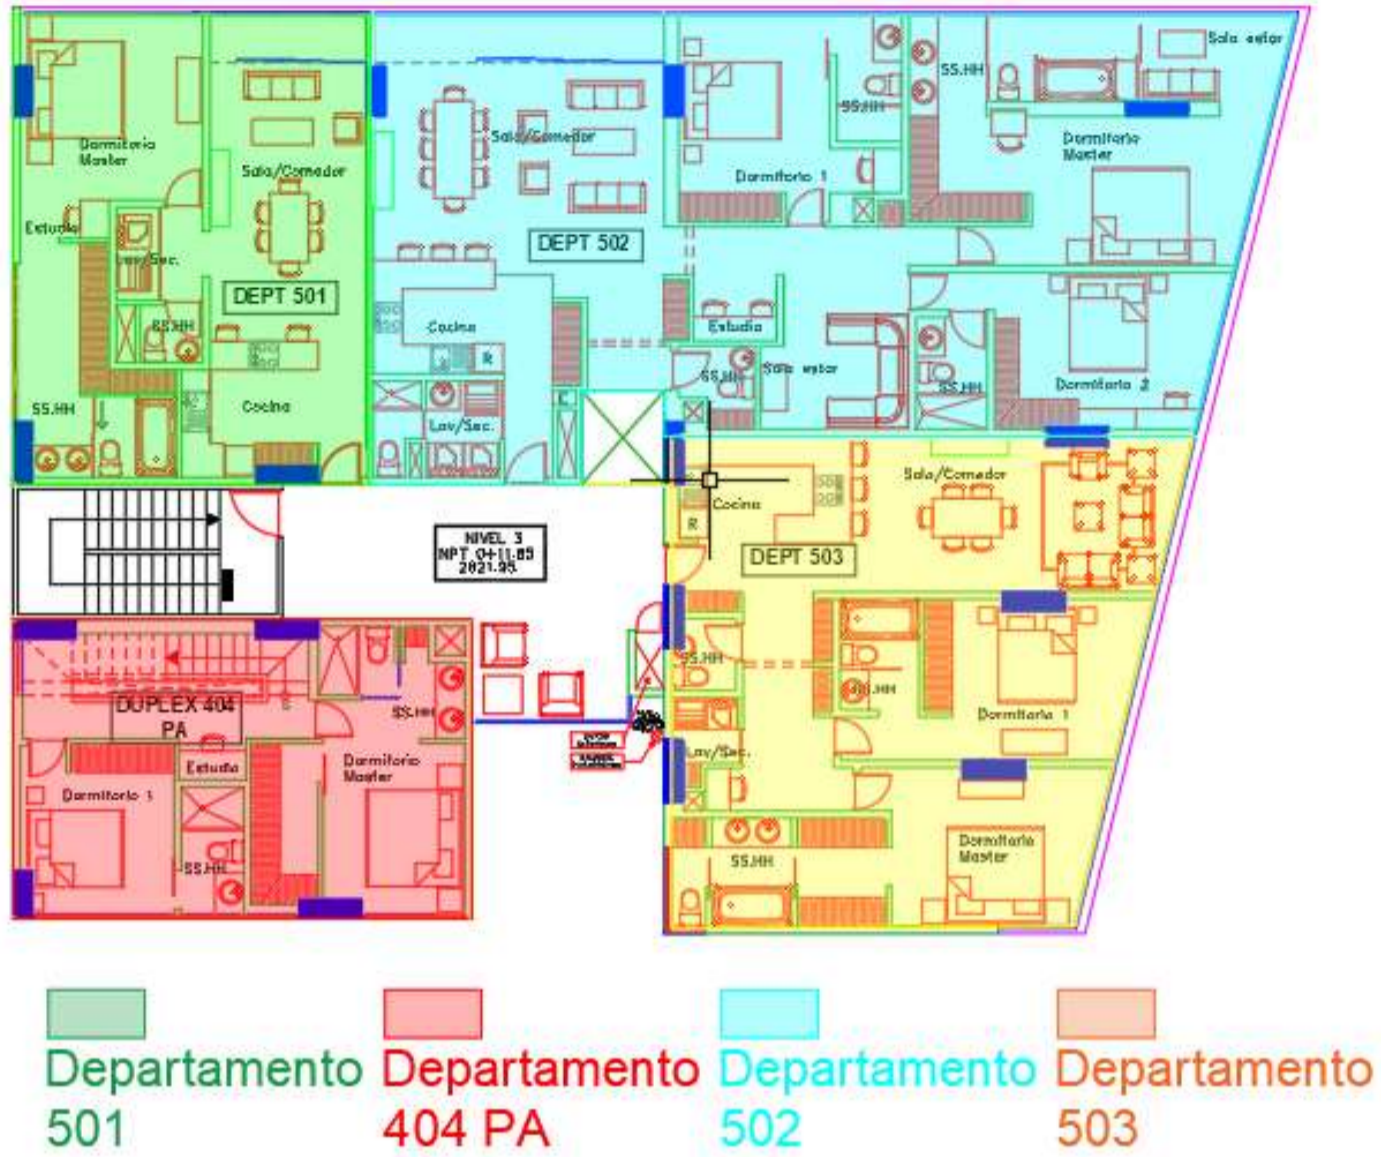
Distribución Arquitectónica Planta Alta 3
